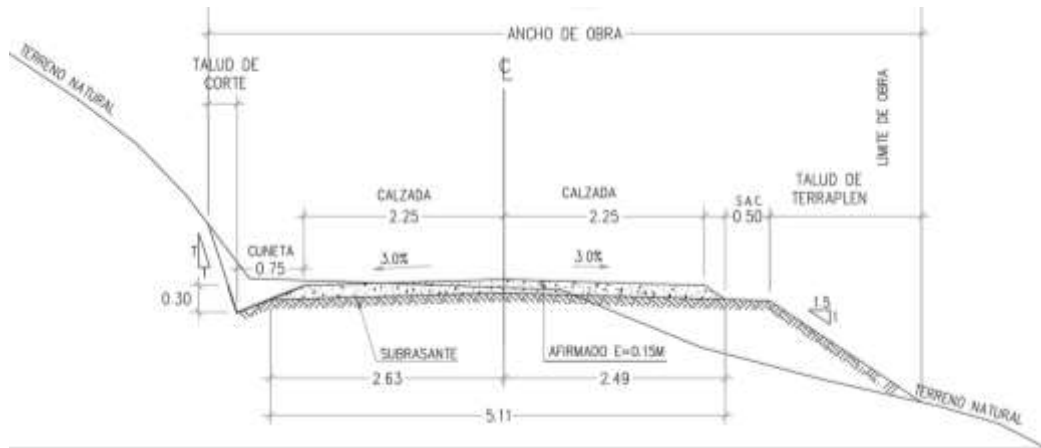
Sección típica a media ladera. Fuente: Plano de secciones típicas
